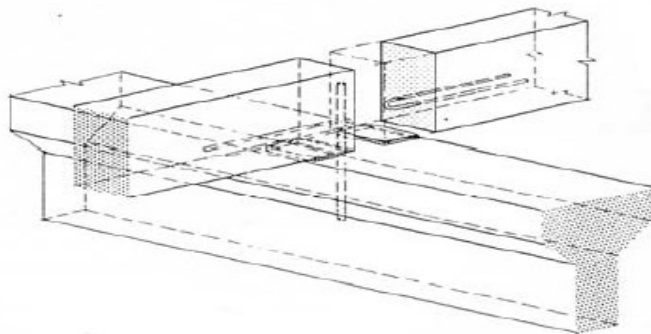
Ligação viga secundária – viga principal através de armaduras em gancho (STUPRÉ, 1981).
